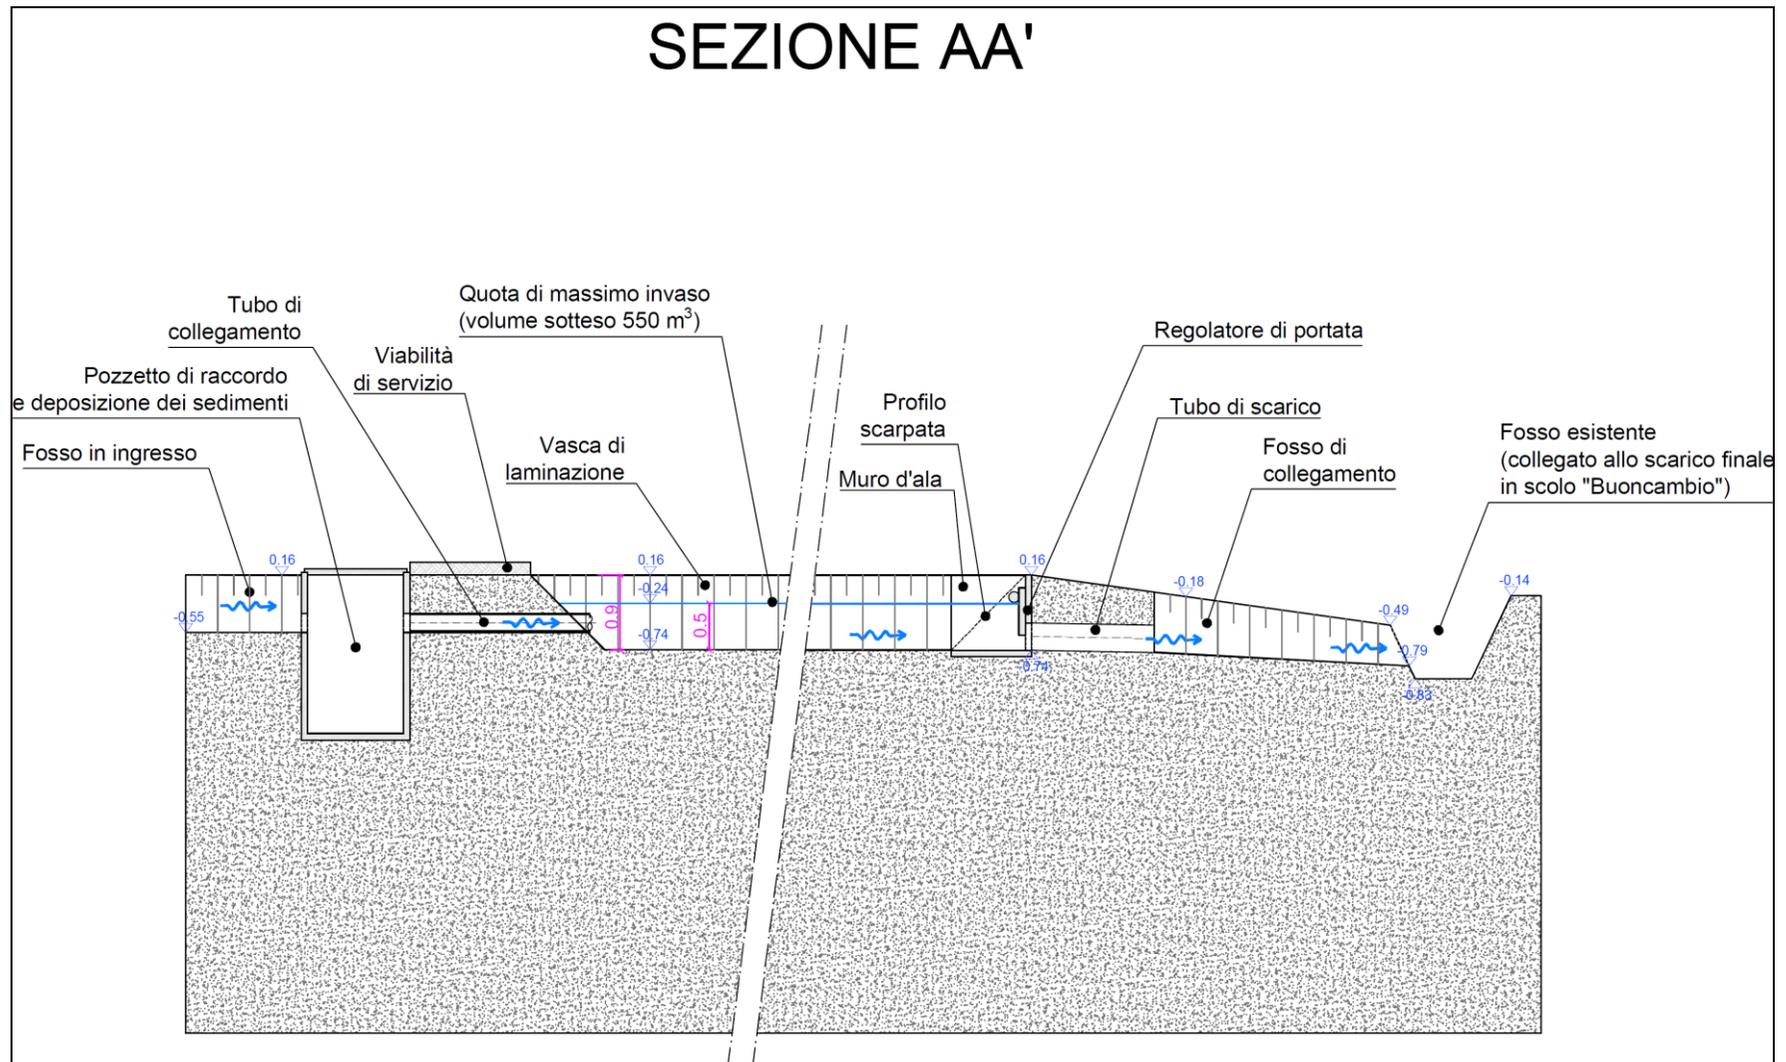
Sezione longitudinale del dispositivo di laminazione predisposto ai fini dell'invarianza idraulica (sezione AA', riferimenti in Figura 18).
